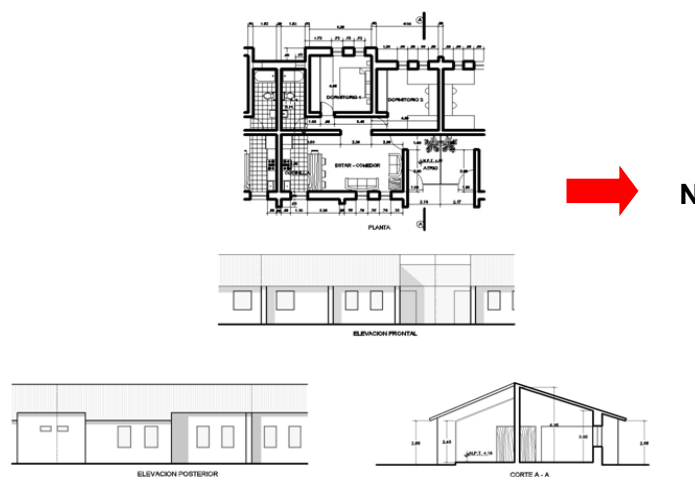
Planta, elevaciones y corte de la edificación propuesta
